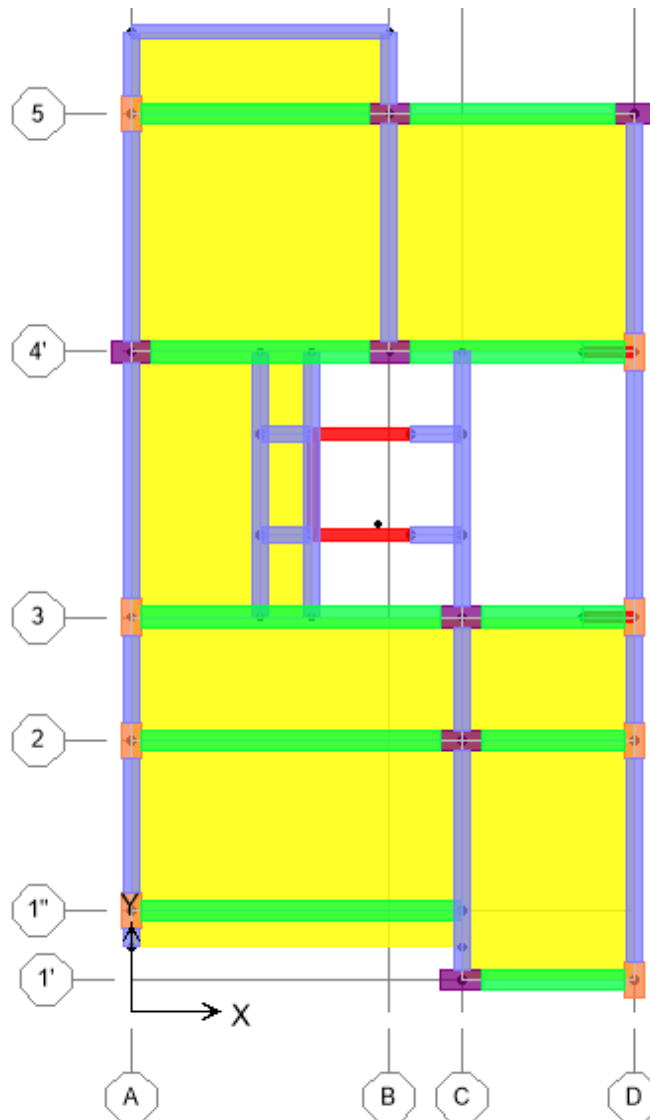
Configuración de vigas general de elementos piso tipo (Etabs) para NSR.10 Y NSR.98
